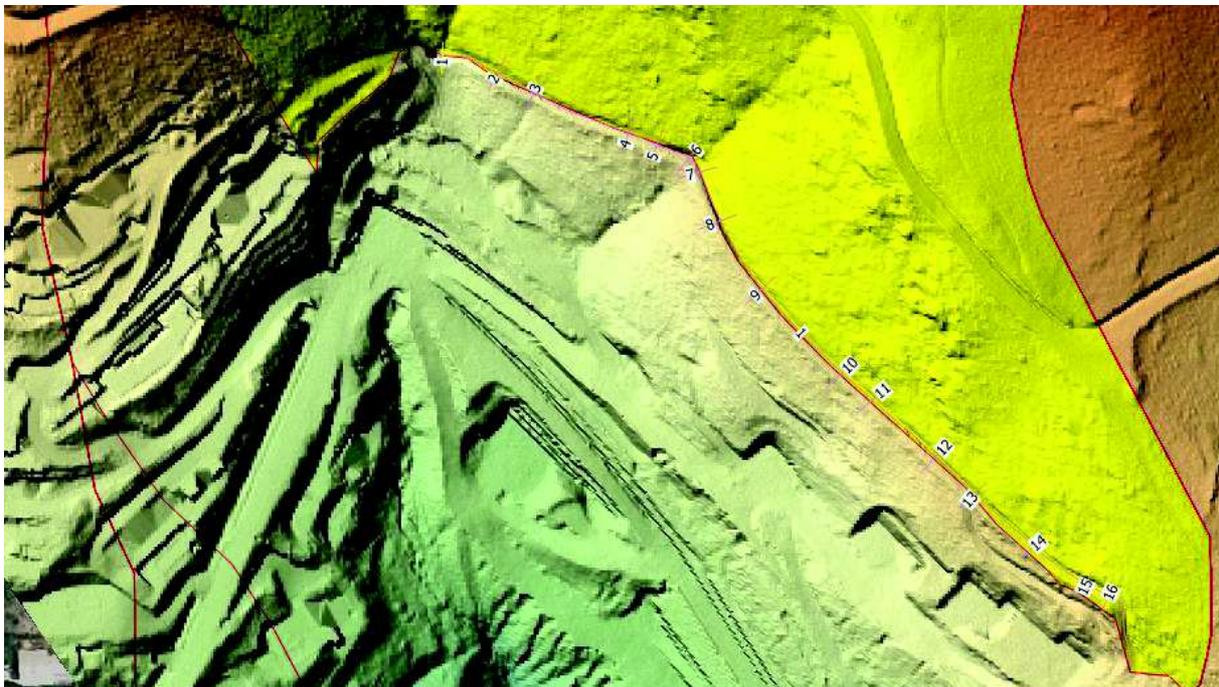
Vue en plan du fossé 1 et localisation des profils en travers
